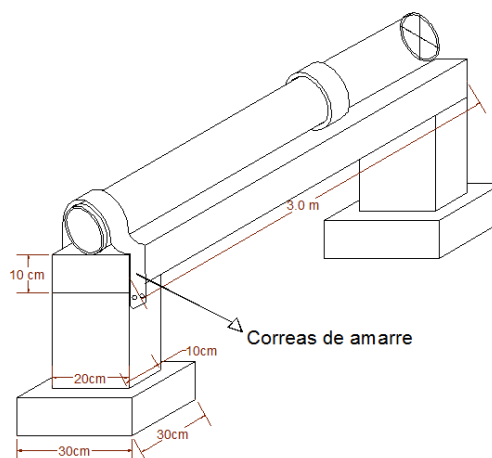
Propuesta de diseño para semiencofrado de la tubería de aducción.
